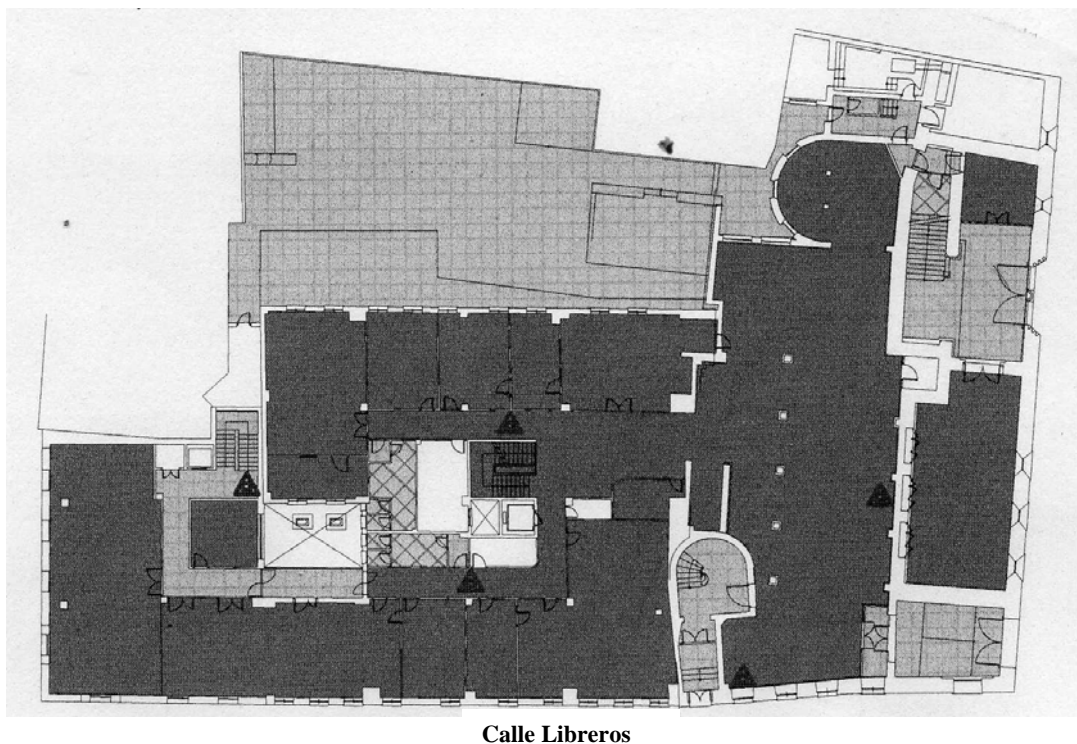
Rectorado y Secretaría General. Planta baja (estado actual).
